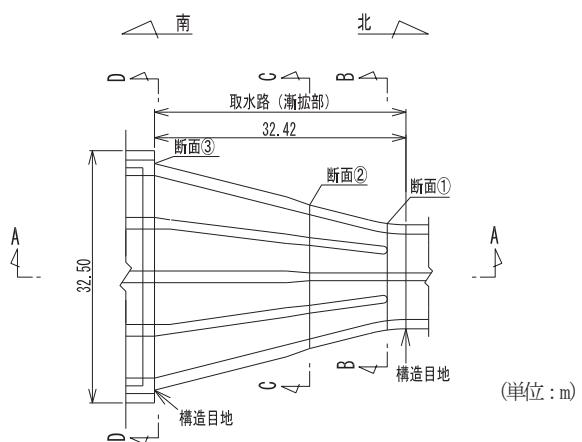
取水路（漸拡部）平面図及び候補断面位置
